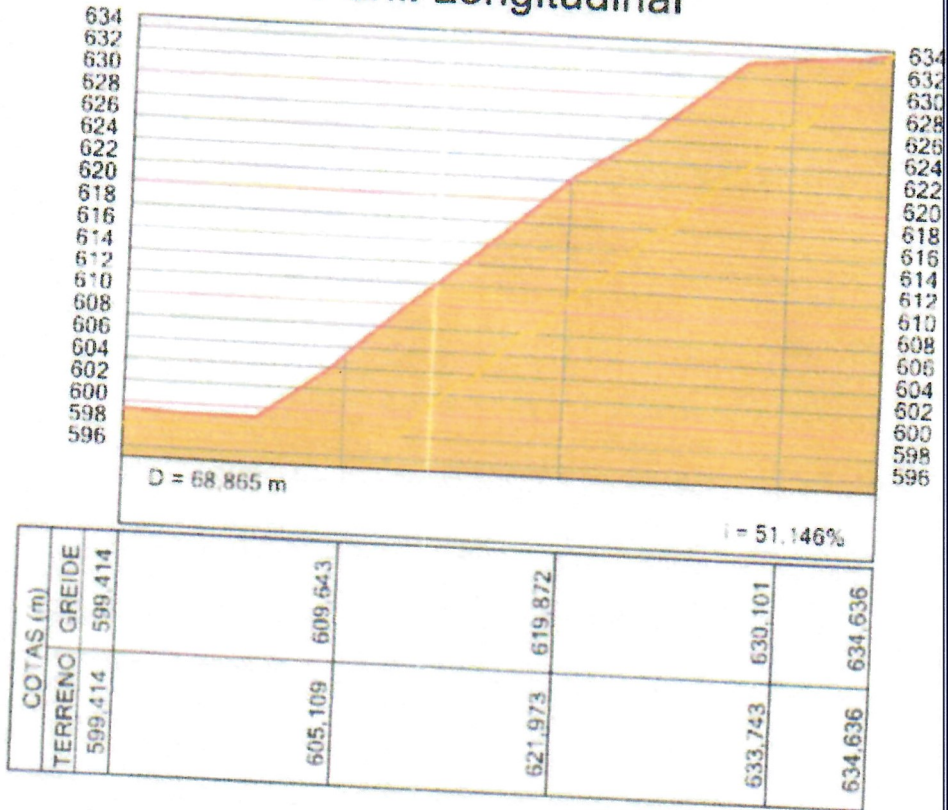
Perfil longitudinal atual e final da área de extração até esgotamento da jazida. Sem escala.
